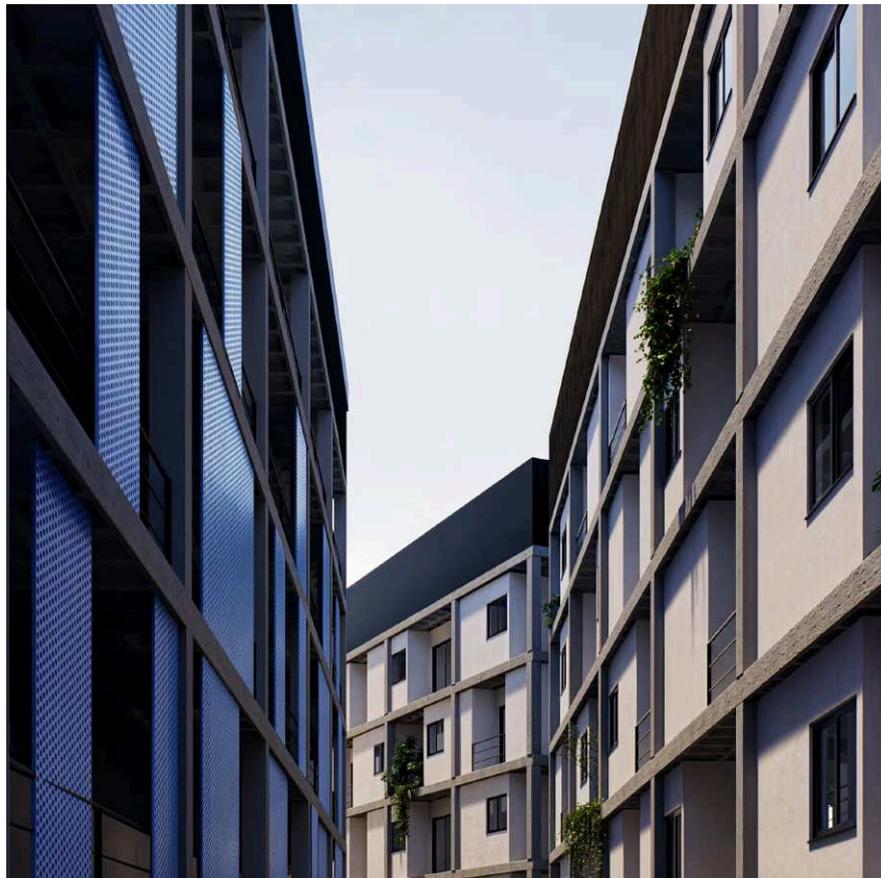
Vista entre blocos, fachadas de painel perfurado e demonstração dos volumes
